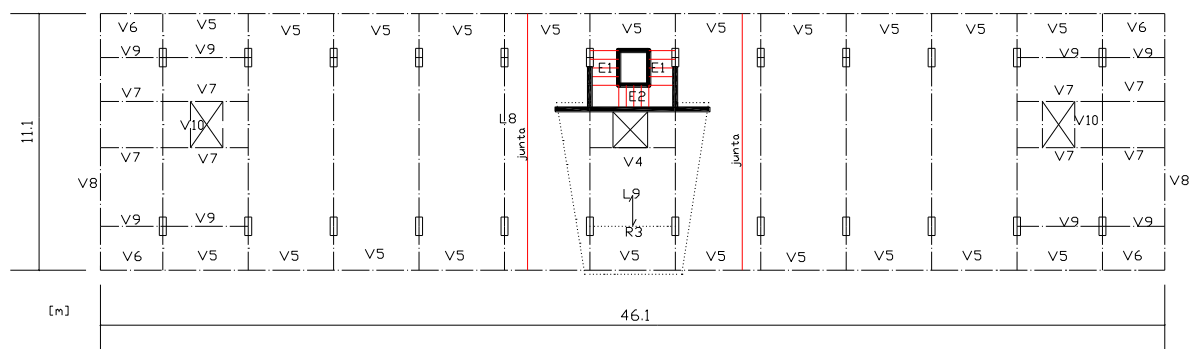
Planta estrutural do edifício (Adaptado de Rodrigues,2005)
